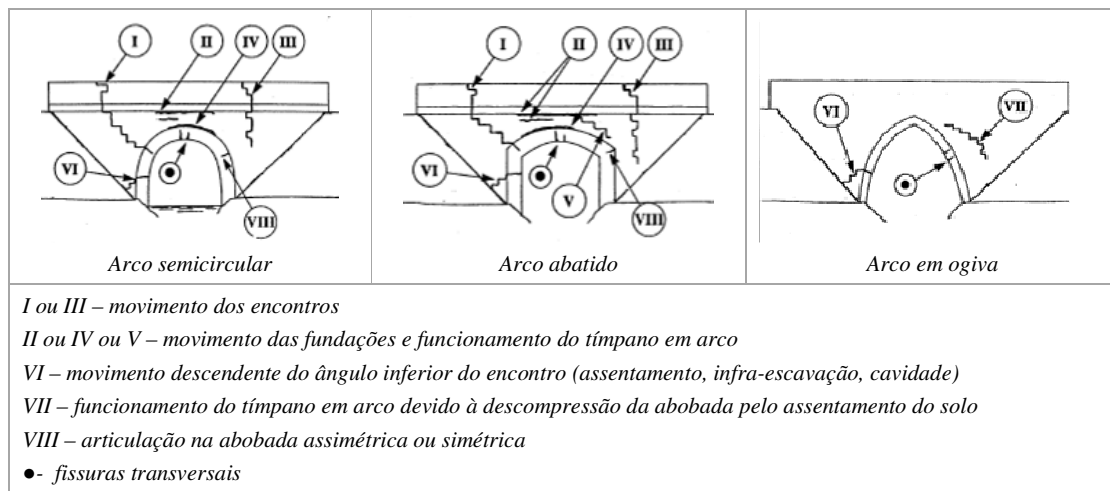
Tipos de fissuras que podem aparecer nos muros tímpano (IQOA 1996)
